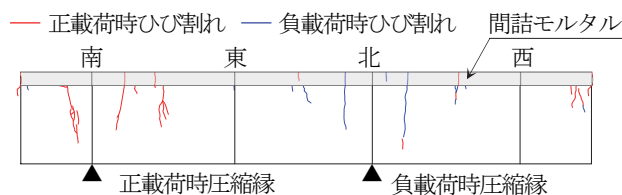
杭体と間詰モルタルのひび割れ発生状況 ($\pm\delta_y$ まで)
